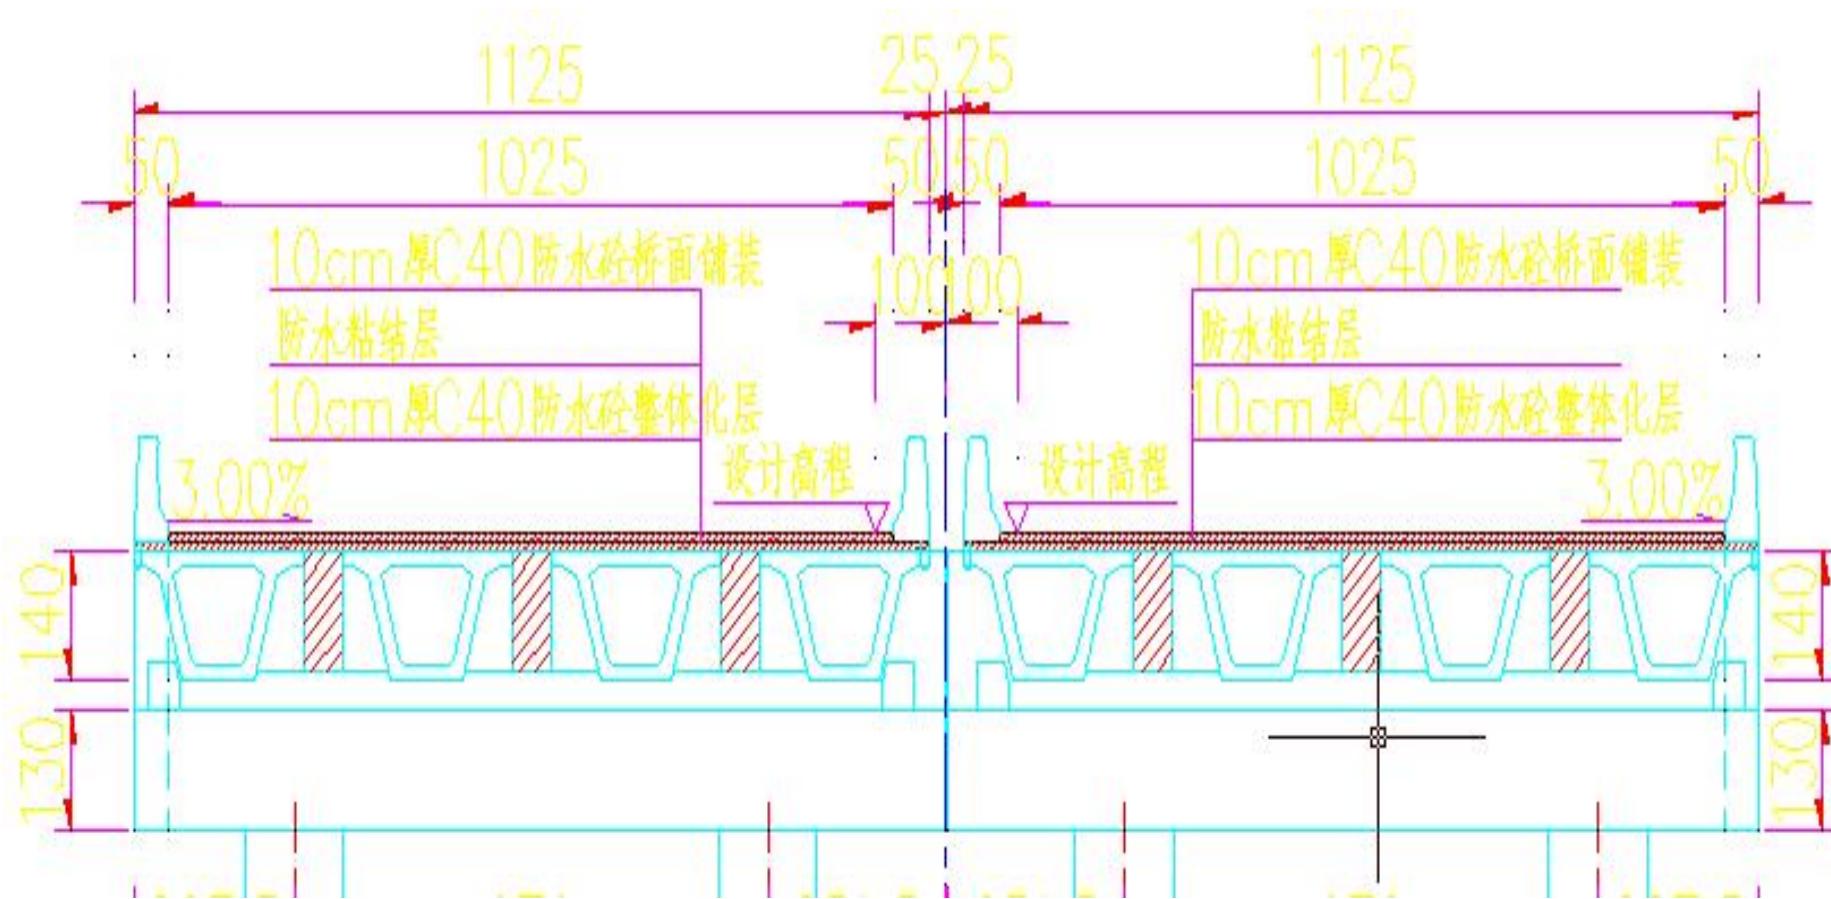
锦江大桥、康溪一号桥的横断面图
